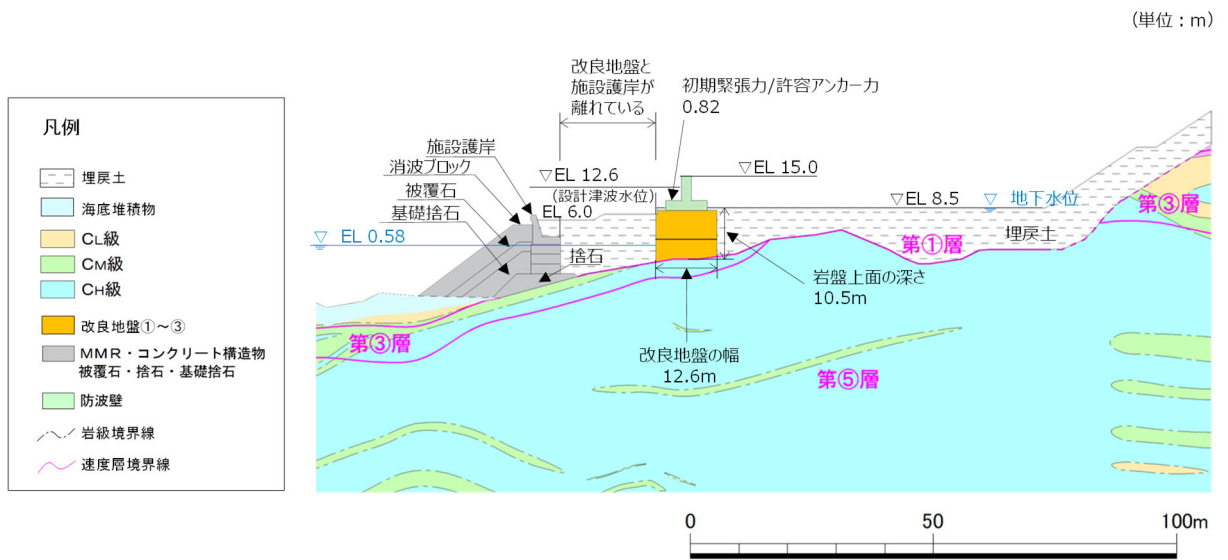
防波壁（逆 T 擁壁）の横断面図（②-②断面）
